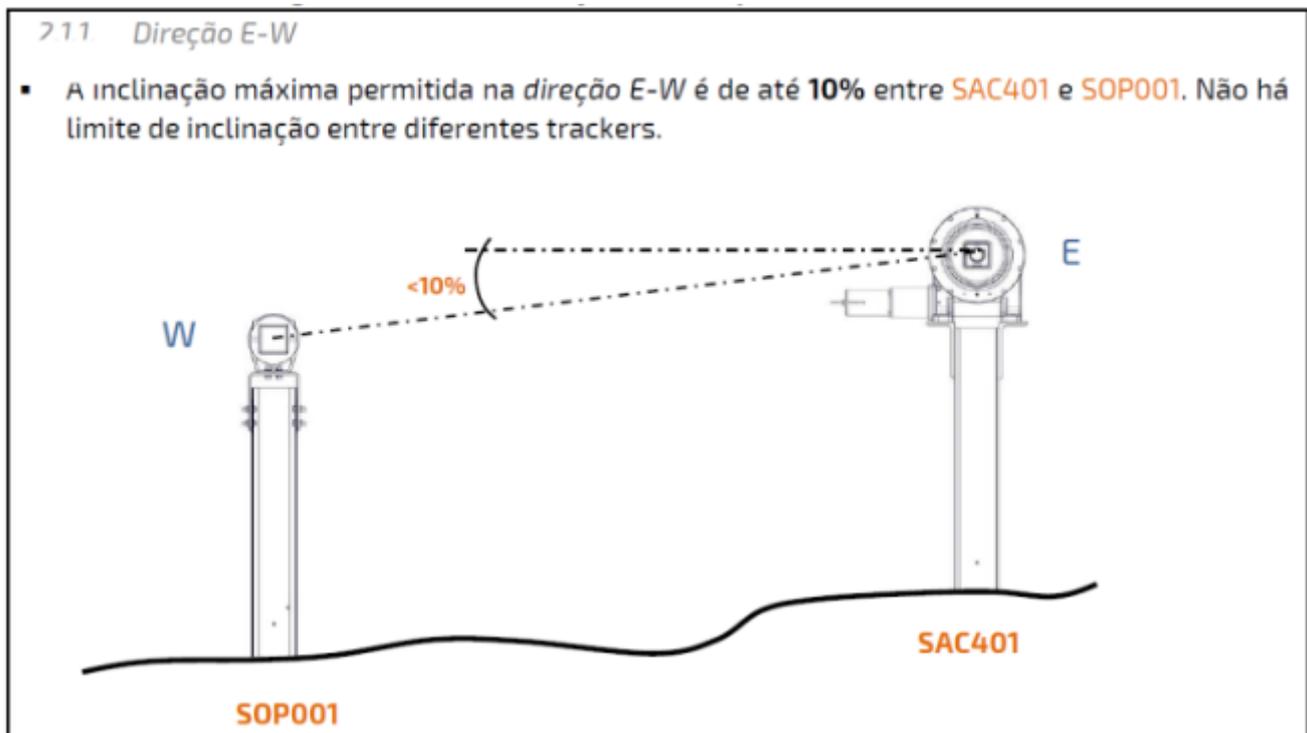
Vista da inclinação entre os pilares da estrutura fixa.
